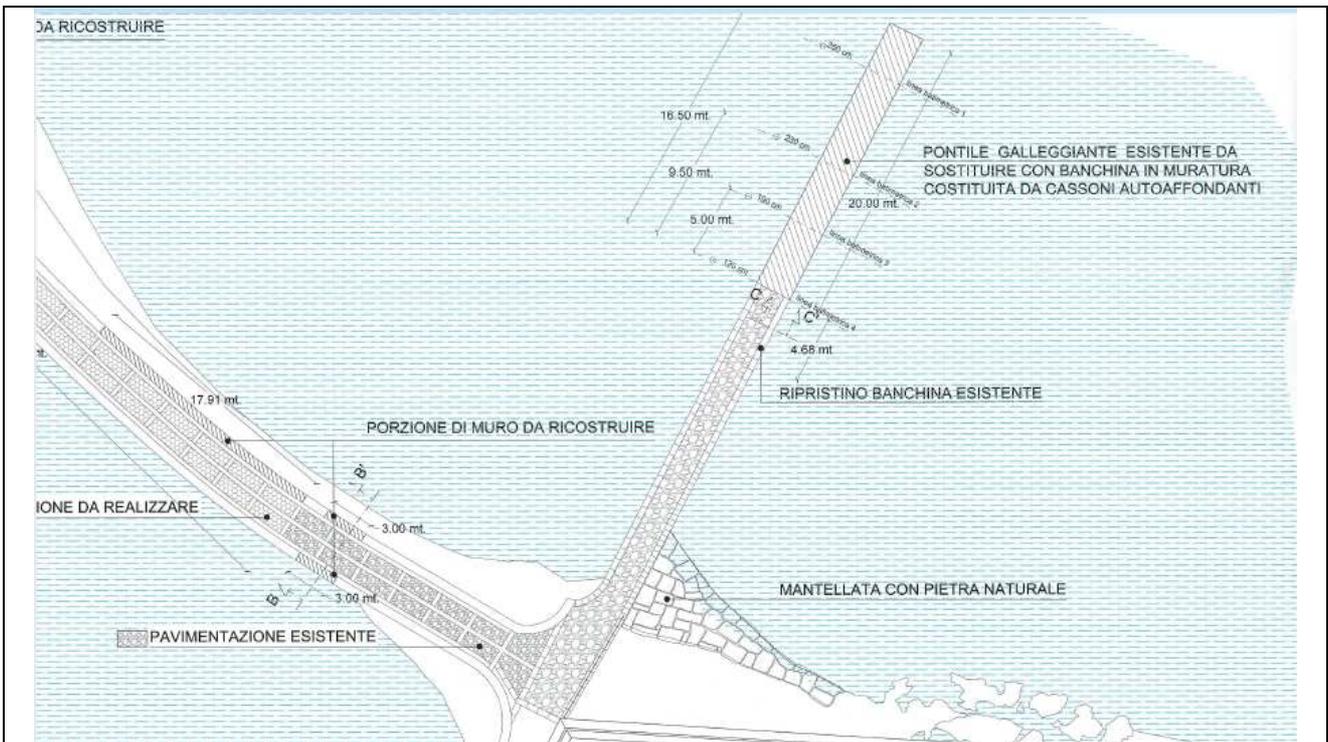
Planimetria di progetto relativa alla sostituzione del pontile galleggiante con un pontile fisso e ripristino della mantellata.
